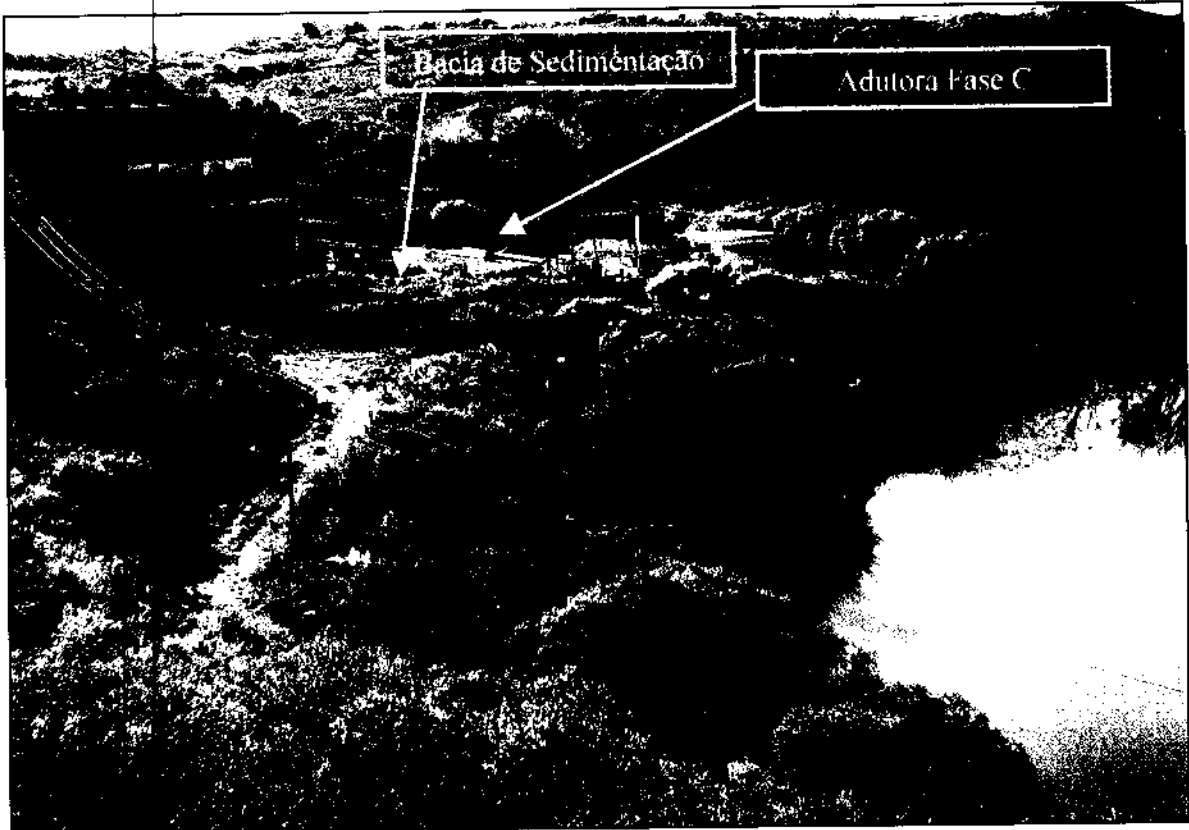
Vista geral da Área com Localização da Bacia de sedimentação.
